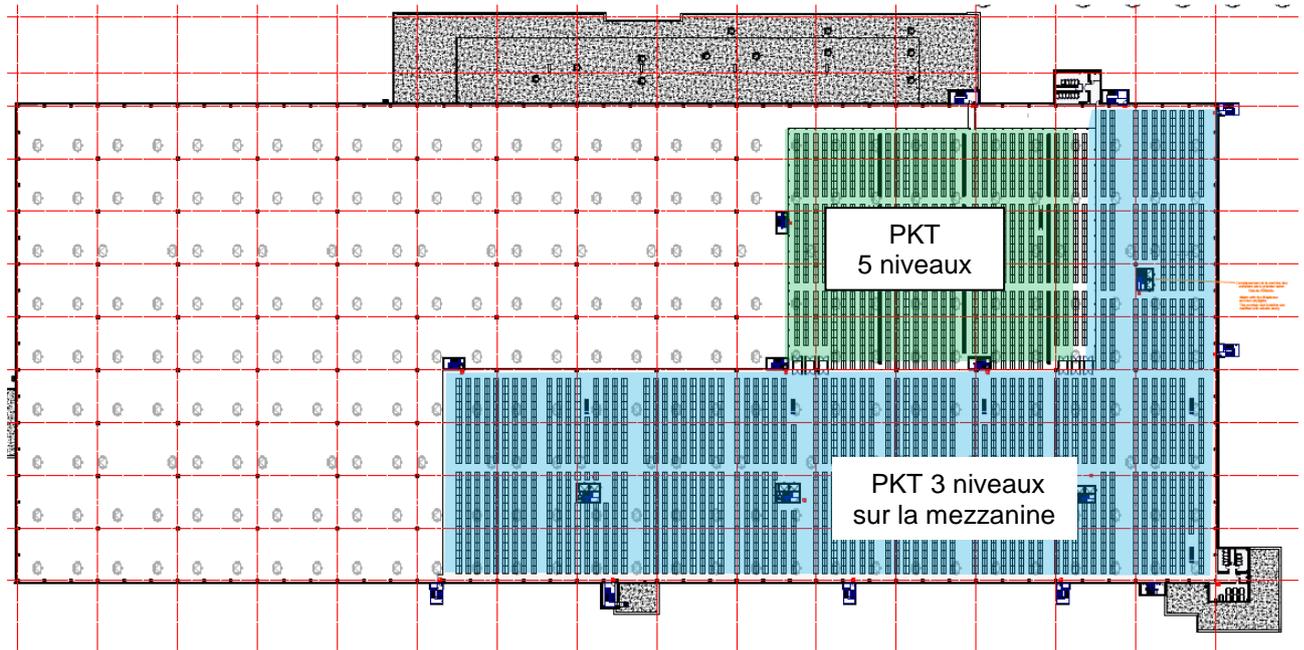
Plan du niveau sur mezzanine – P2 (+6,00 m)
